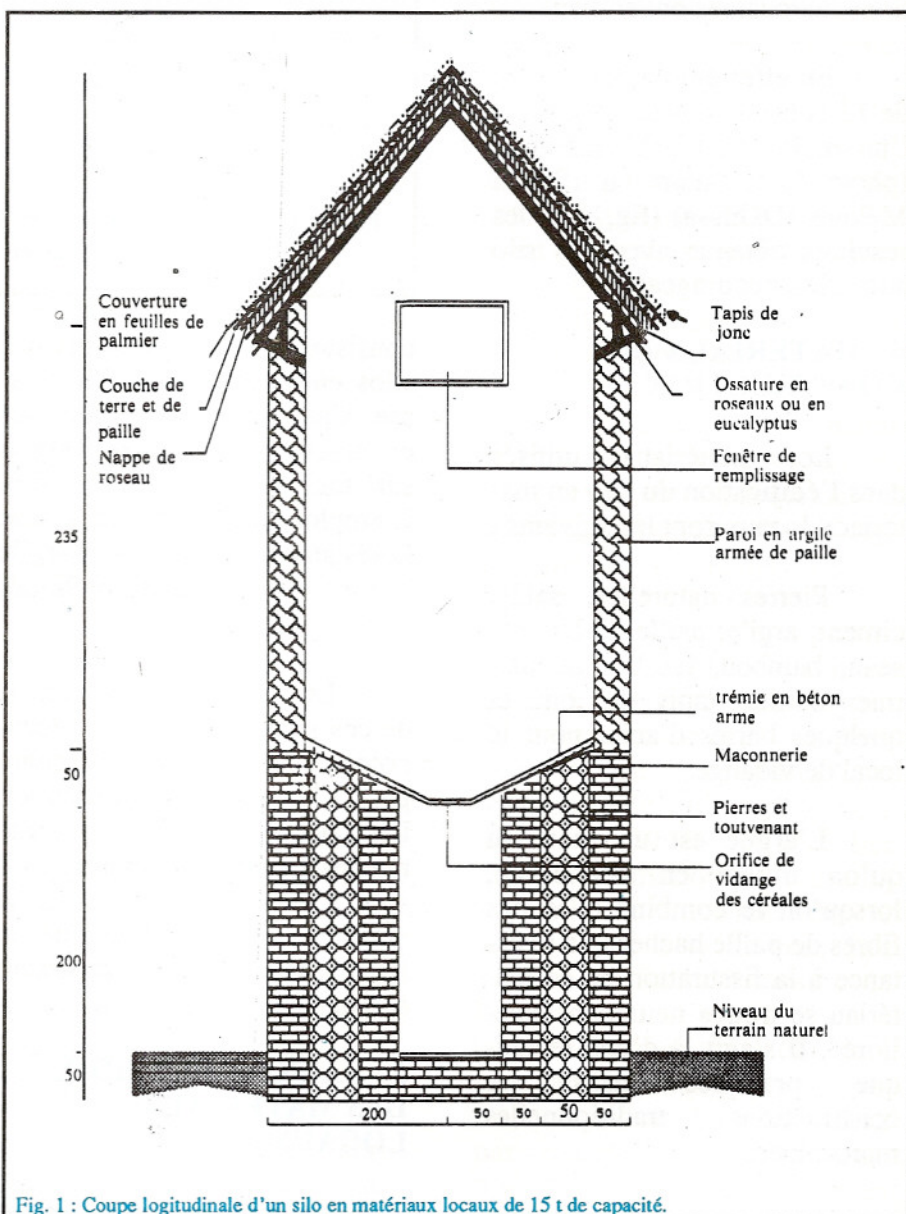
Coupe longitudinale d'un silo en matériaux locaux de 15 t de capacité.
